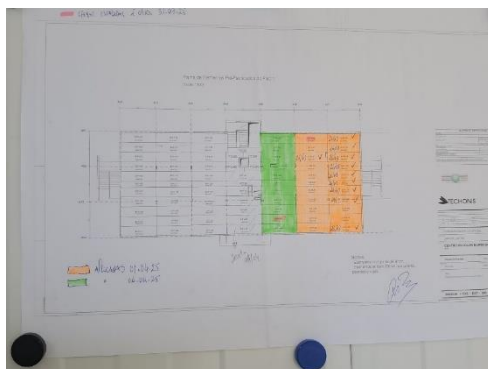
Gestão Visual aplicada à instalação de lajes pré-fabricadas
